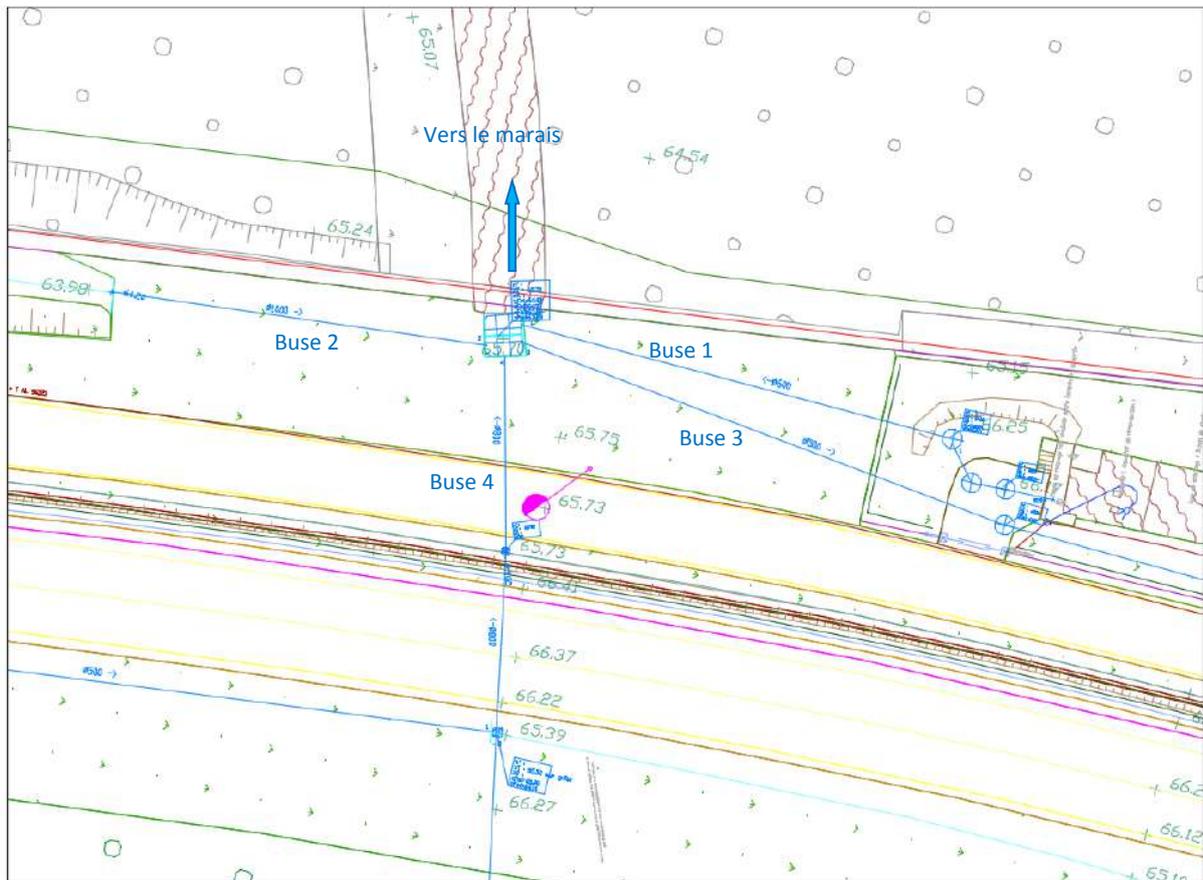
Extrait du plan de masse des installations de traitement des eaux pluviales de l'A6 (source APRR)
